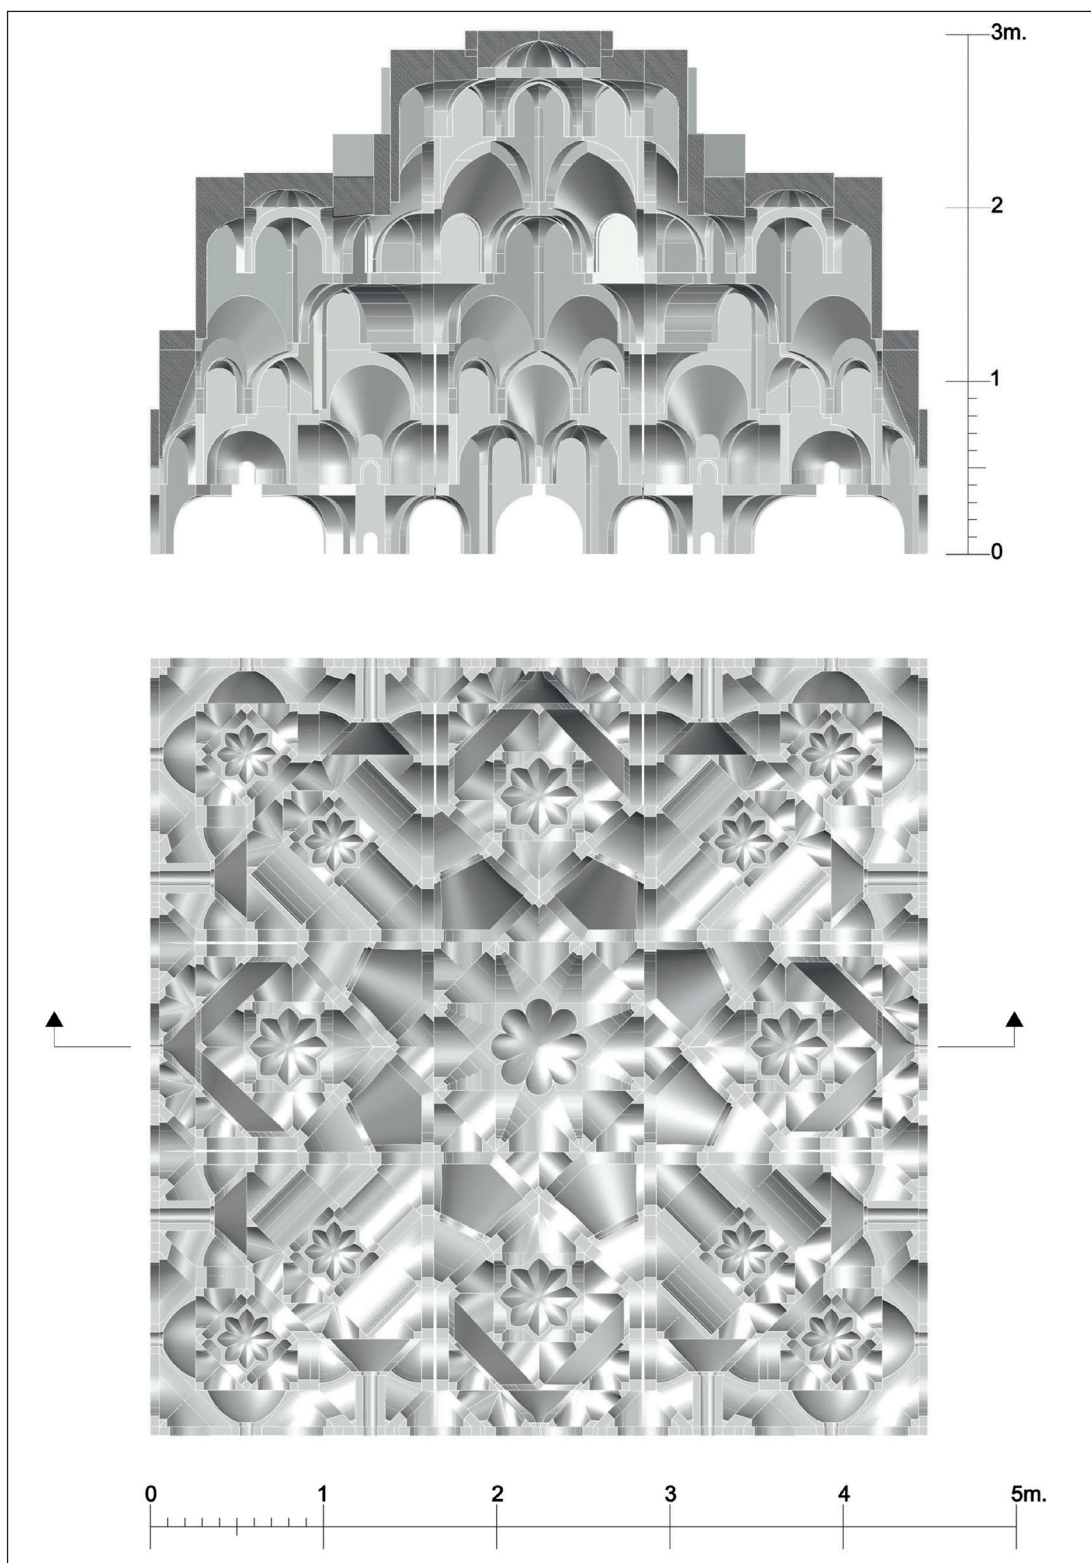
Planta y sección del modelo tridimensional elaborado para la bóveda T1.
